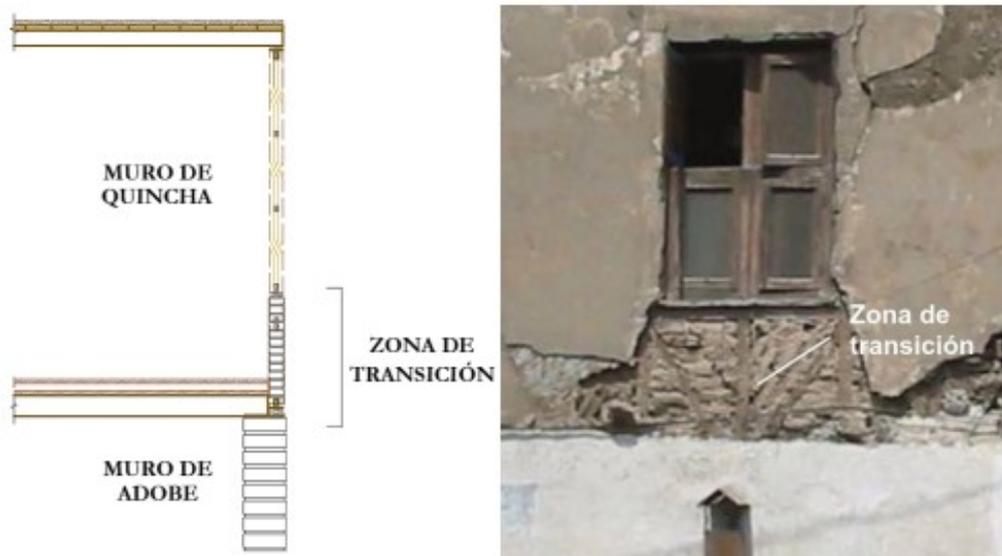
Zona de transición del sistema mixto Adobe-Quincha
